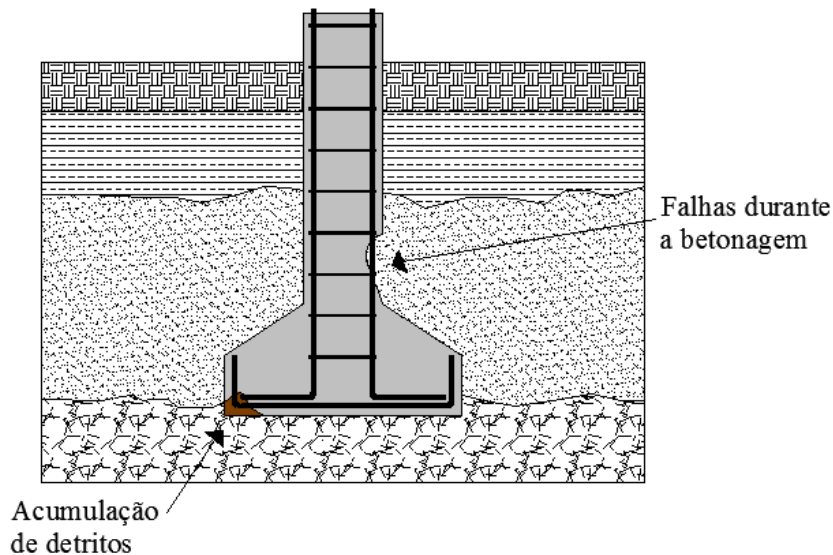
Surgimento de problemas durante a betonagem devido a detritos que não foram limpos ou má disposição das armaduras (Modificado, Schnaid et al., 2005).
